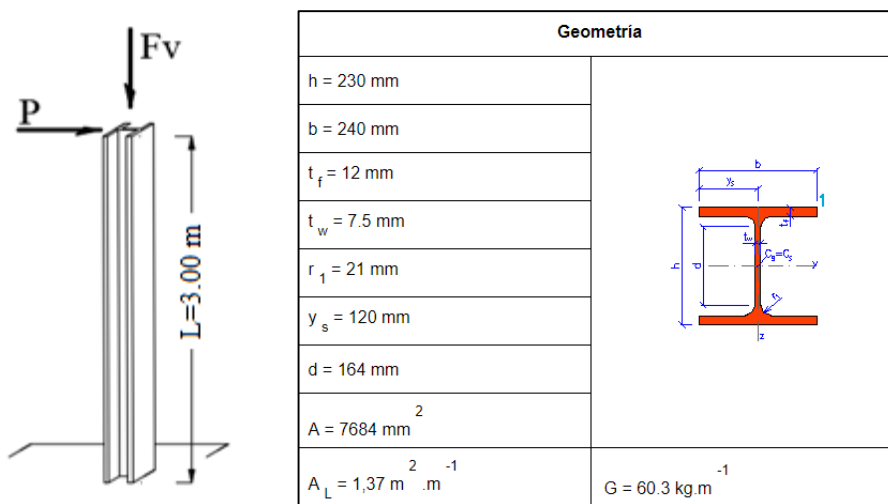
Columna metálica y propiedades geométricas de la sección de acero HE240.
